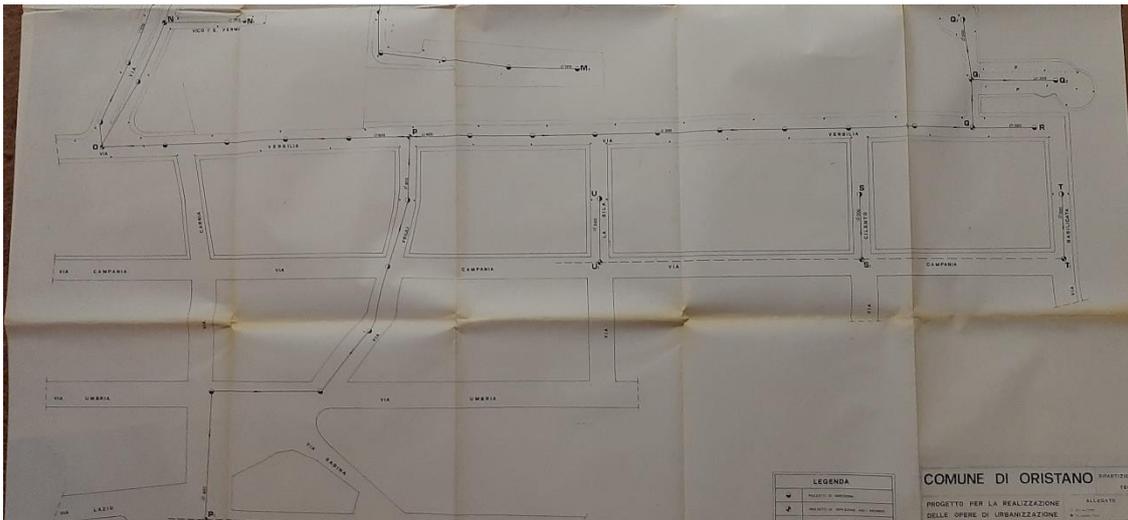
Planimetria progetto del '88 opere urbanizzazione Torangius.
